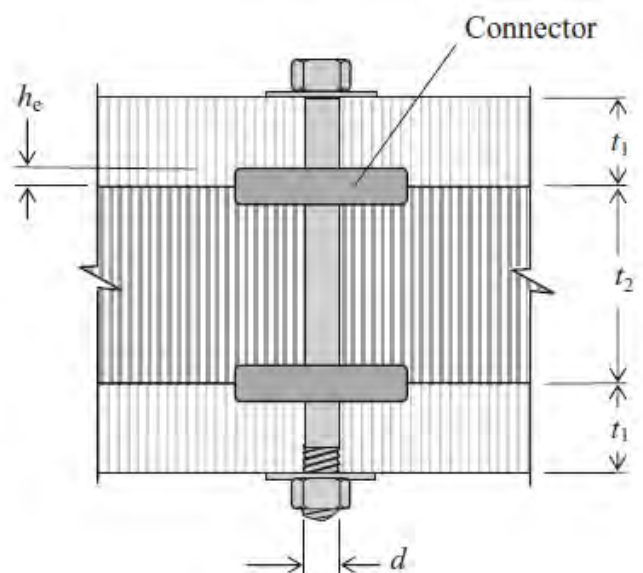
Dimensões relevantes para ligações anéis ou placas metálicas
